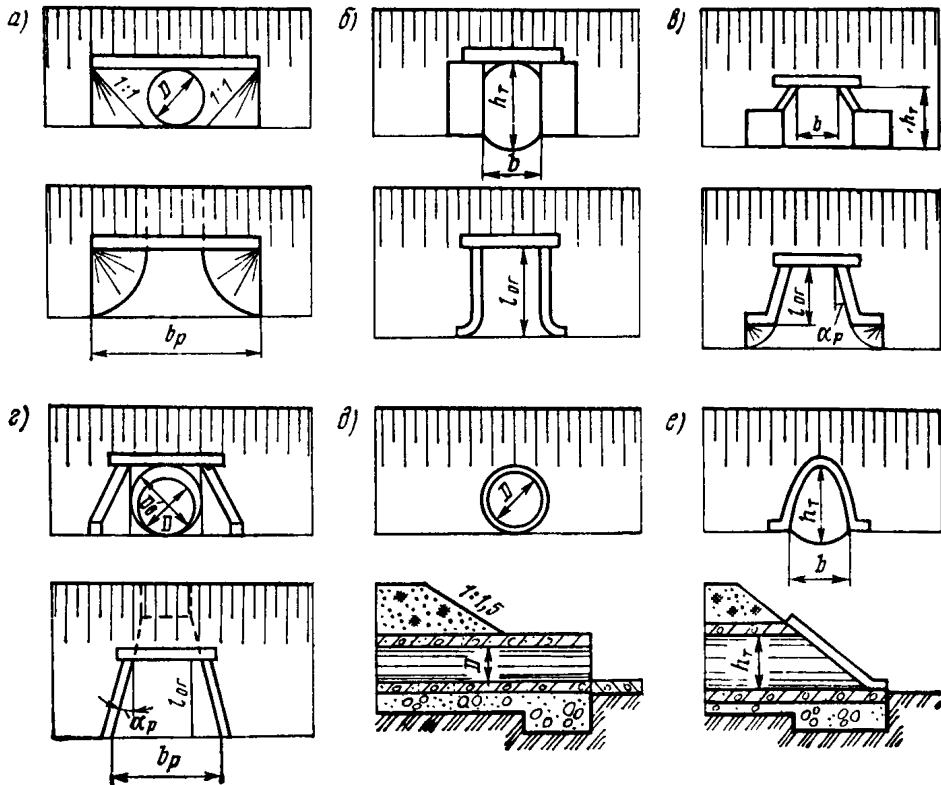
Формы и типы оголовков водопропускных труб (а—г — фасад и план; д, е — фасад и продольный разрез):
